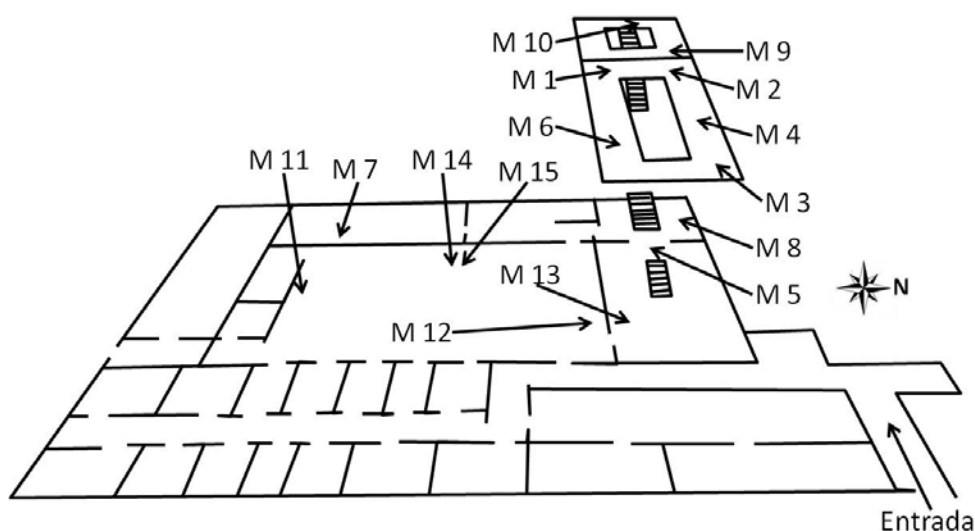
Posiciones de los sensores instalados en el Museo Comarcal de Molina de Aragón.
